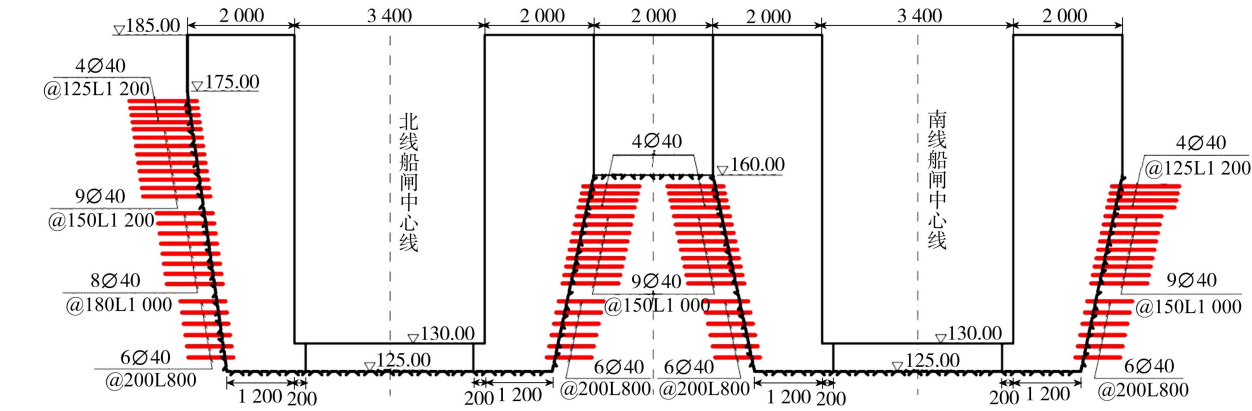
结构、锚杆剖面布置图(高程单位:m;锚杆直径单位:mm;其他尺寸单位:cm)
